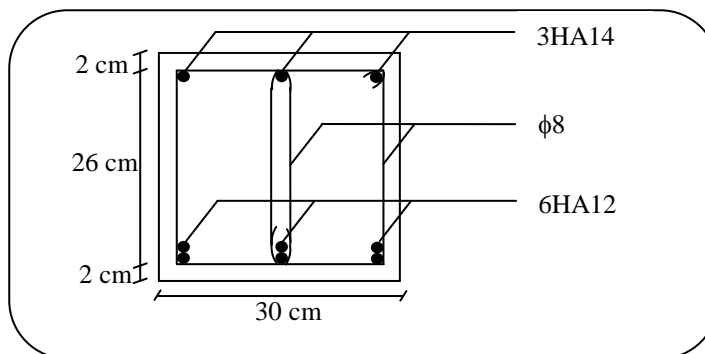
Schéma de ferrailage de la poutre palière
